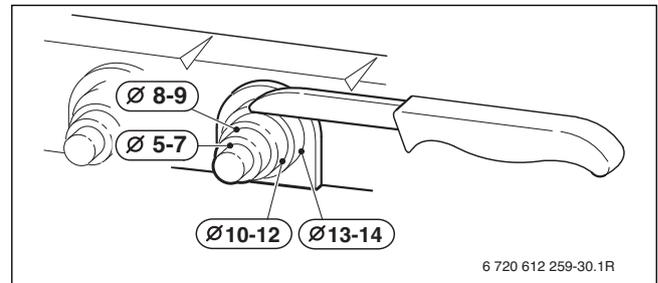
Zugentlastung an Kabeldurchmesser anpassen
